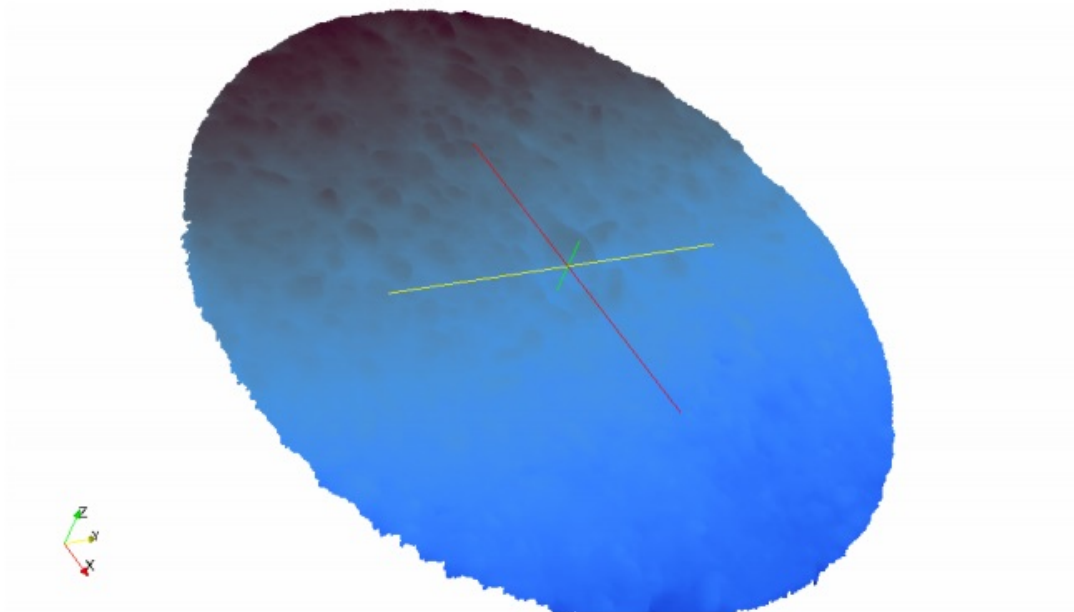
Perfilamento tridimensional com 3 leituras do pavimento asfáltico.
